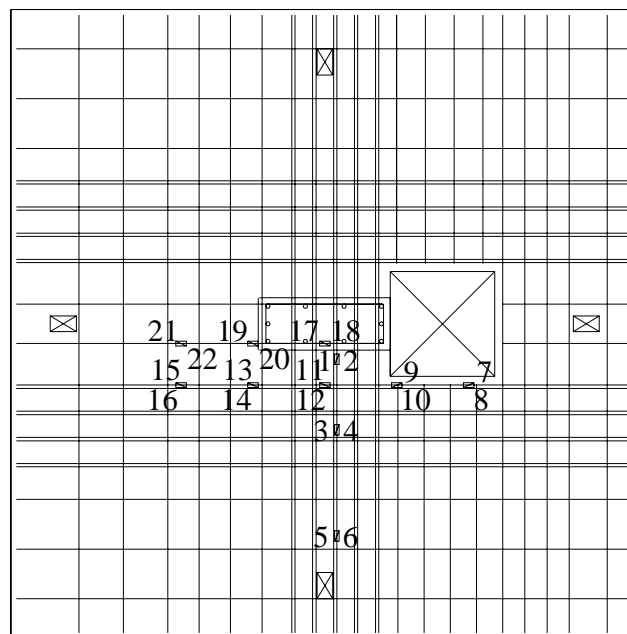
Posicionamento dos extensômetros da laje L3
